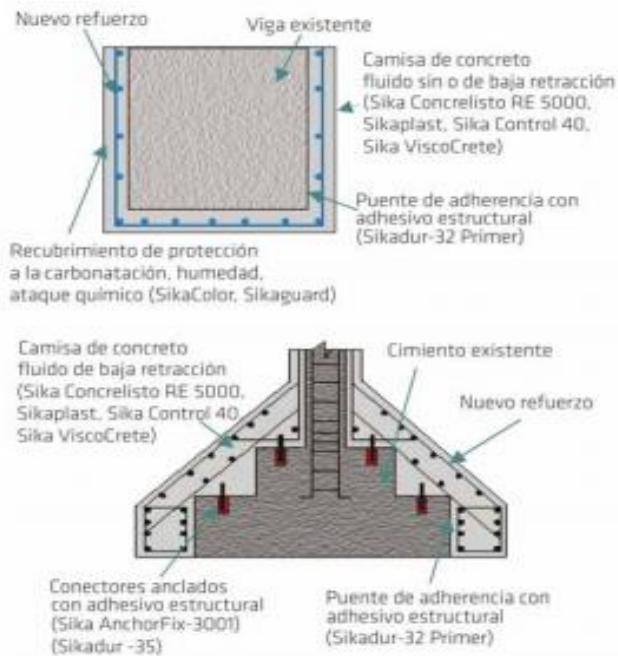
Encamisado en concreto reforzado de una viga y de cimentación. Fuente: SIKA-Construyendo confianza.
